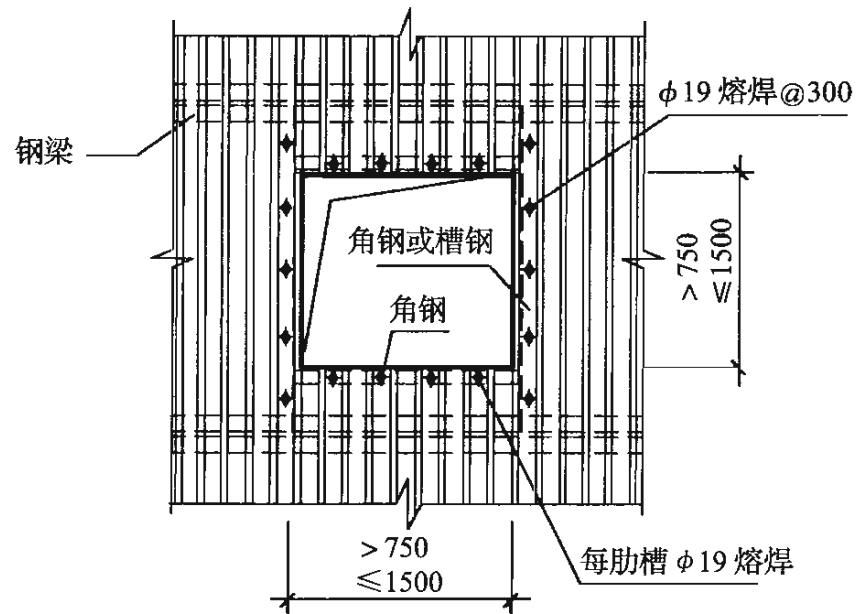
压型钢板开孔洞口加强示意图 (二)
